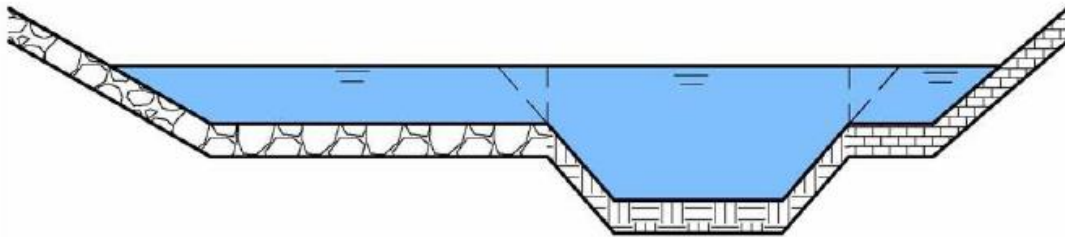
Canal compuesto por una sección principal y dos secciones laterales.
